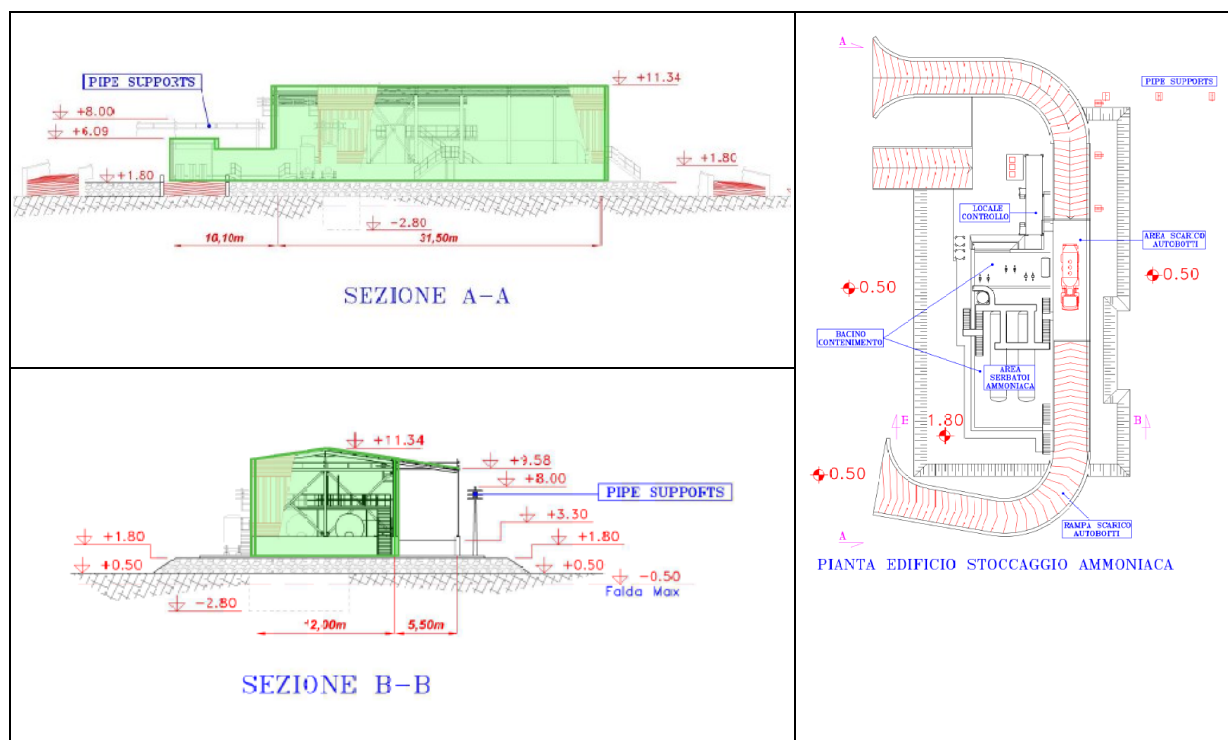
Centrale di Porto Corsini - Progetto di upgrade: sistemazione dell'edificio stoccaggio ammoniacca.
